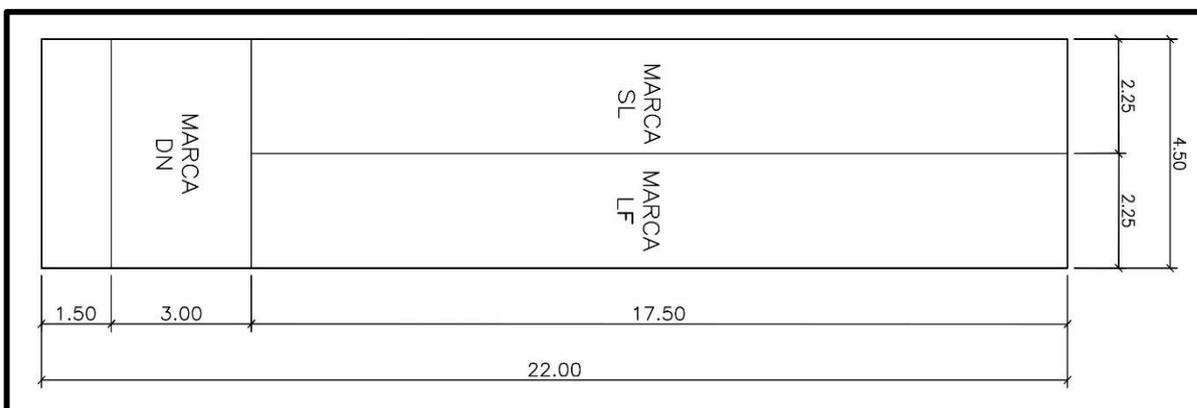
Layout propuesto del tercer piso del almacén. Fuente: Elaboración propia
